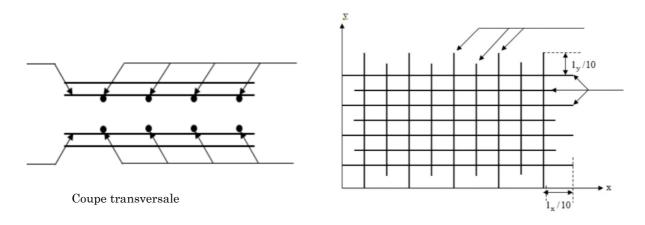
Schéma de ferraillage de la dalle d'ascenseur.
